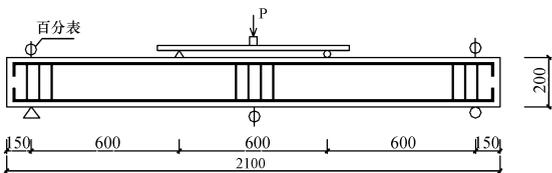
碳纤维增强塑料筋普通混凝土梁试件简图
